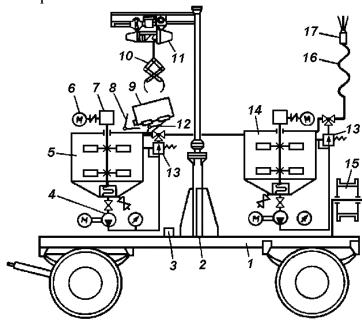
Схема передвижной станции для устройства безрулонных кровельных покрытий
